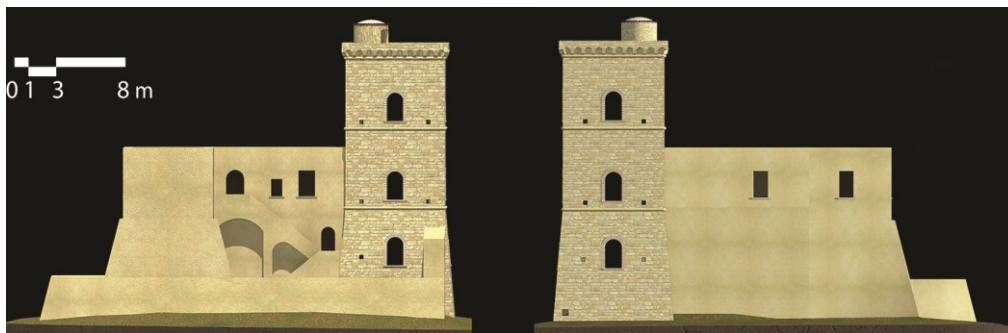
Ricostruzione virtuale dello stato originale; prospetto Sud-Est, prospetto Nord-Ovest
